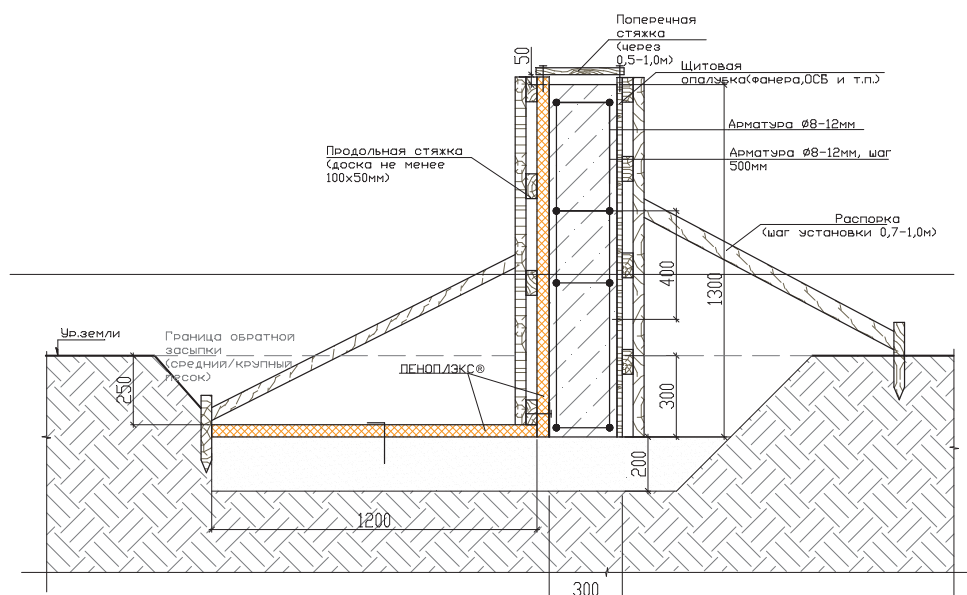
Схема устройства опалубки из плит ПЕНОПЛÉКС® в процессе монтажа ленточного фундамента.
